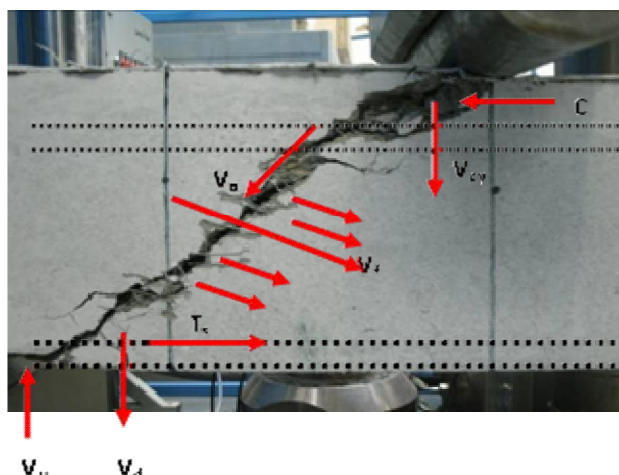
Forces internes de résistance au niveau d'une fissure diagonale pour une poutre en BHP fibré sans armatures transversales
